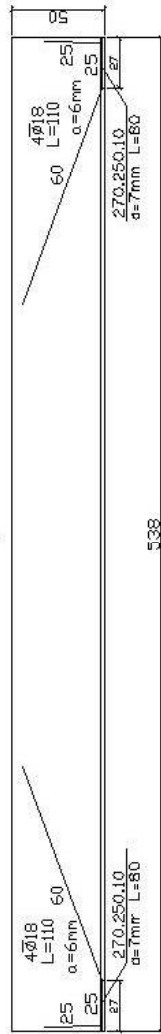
Prefabrike sanayi yapısı S2A kolonu detayı
